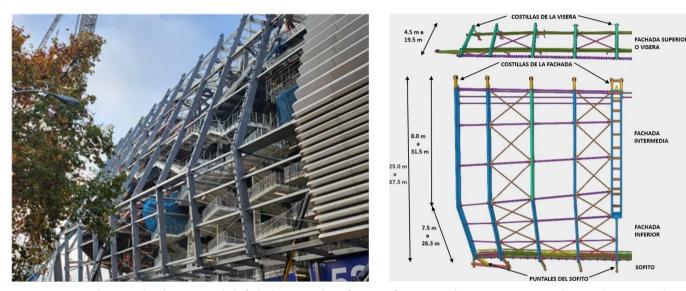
Derecha: Vista de subestructura de la fachada intermedia, inferior y sofito. (Copyright © 2024 Nuevo Estadio Bernabéu) Izquierda:
